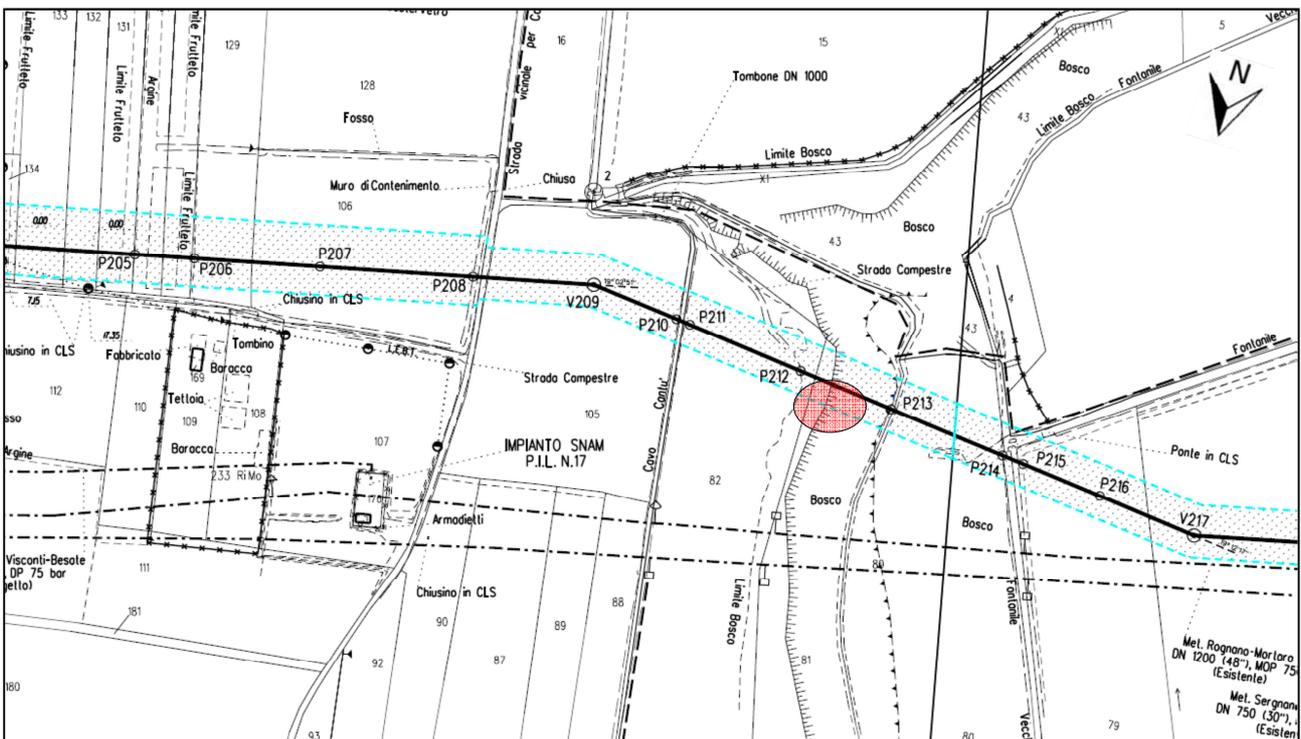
Localizzazione Area Test VEP 01 BS su planimetria catastale
